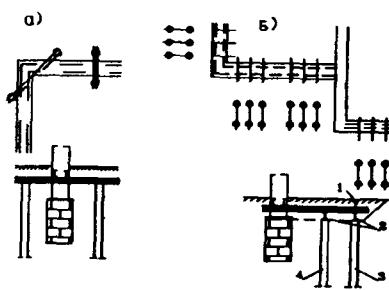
Передача нагрузок в существующих зданиях на выносные опоры.
